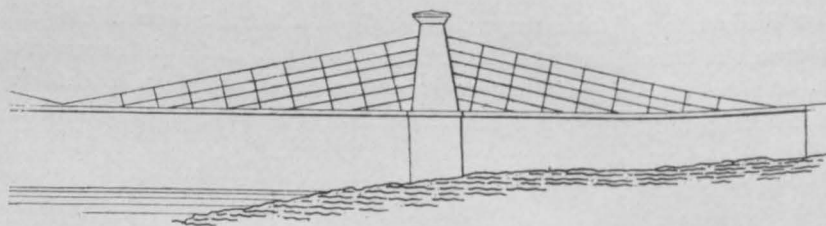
Kettenbrücke der Bauart HATLEY, 1840.
